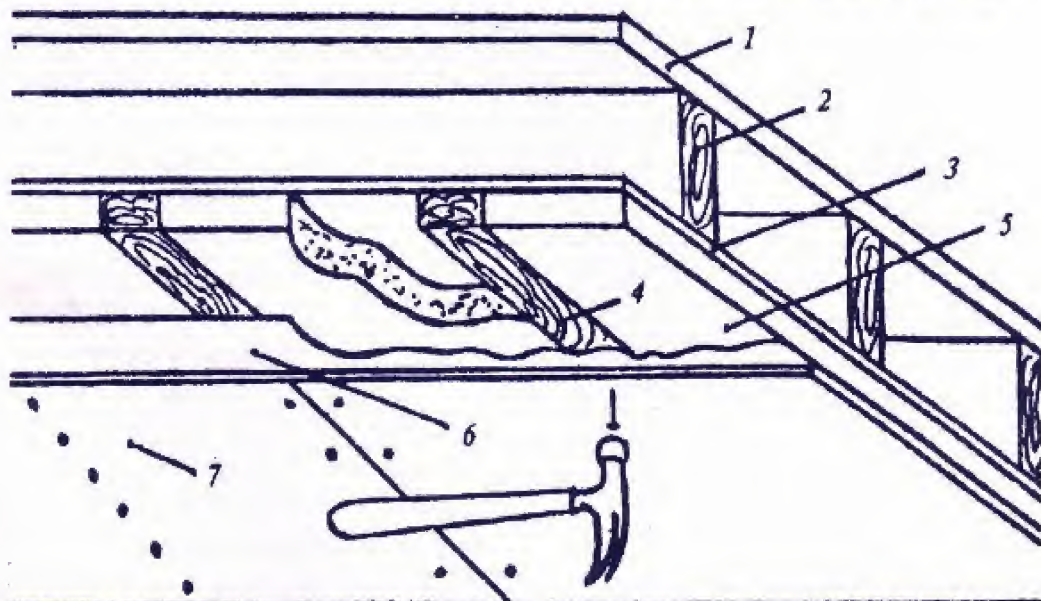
Внутрішнє утеплення плоского даху: 1 – покрівля; 2 – несуча конструкція; 3 – стеля; 4 – планка; 5 – теплоізоляційна стрічка; 6 – поліетиленова плівка; 7 – декоративна панель.
